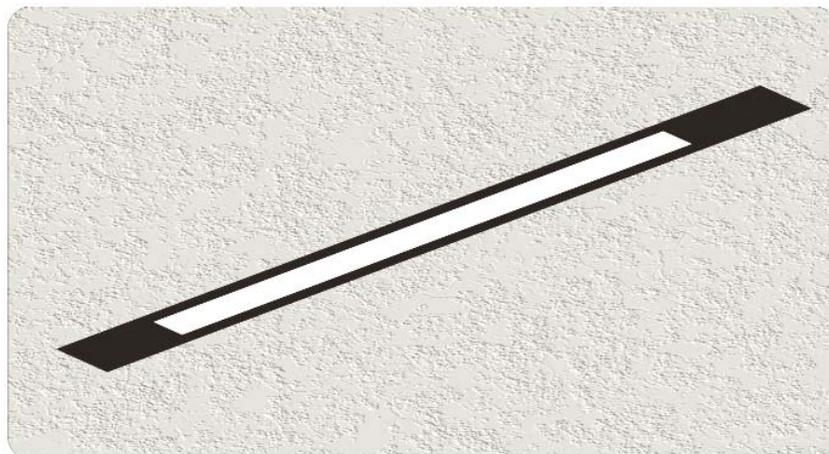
Demarcación en pavimentos de concreto (rígidos)
